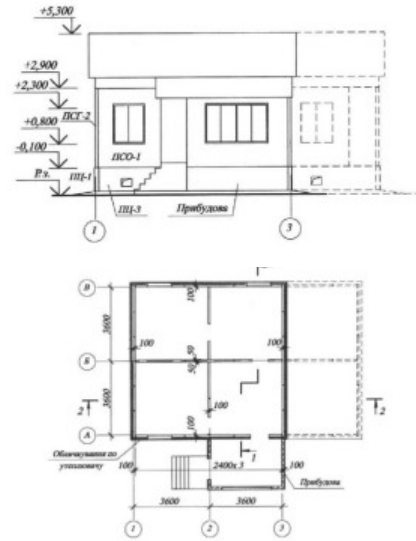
Основні технічні рішення системи «Залізобетонна панель»: а) - фасад 1-3; б) - план на позн. 0,000 / Basic technical solutions «Reinforced concrete panel»: а – facade 1-2, в - plan at elevation 0,000
